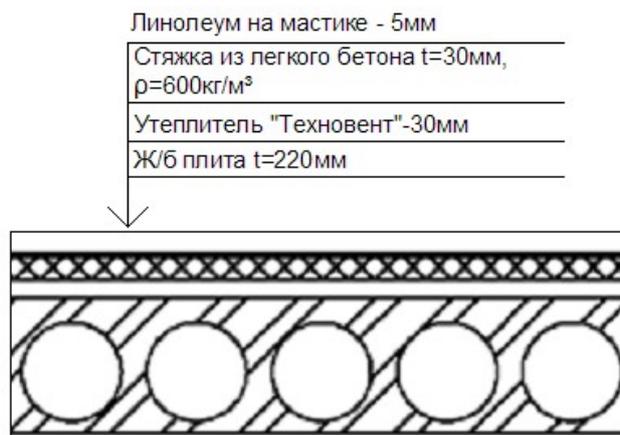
Сбор нагрузок на 1 м^2 межэтажного перекрытия
